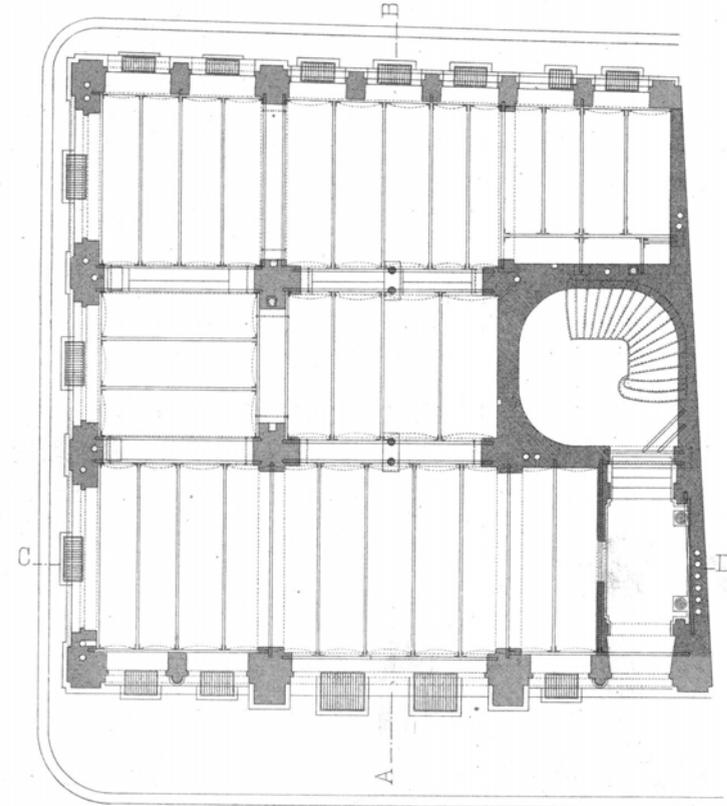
Grundriss Haus am Hof, Parterre
